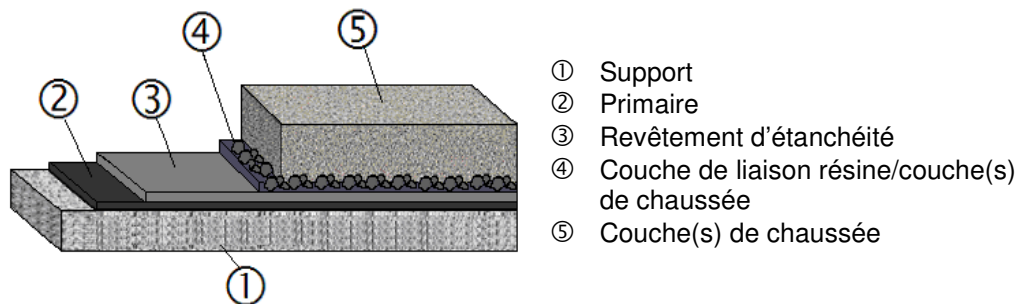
Coupe type SEL A avec couche de chaussée en enrobé bitumineux ou en asphalté pour VL et PL
